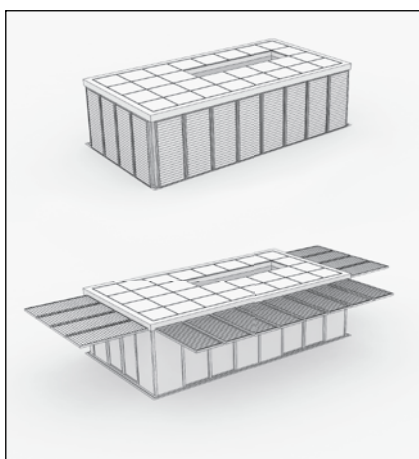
Fassade runtergeklappt, Fassade hochgeklappt
